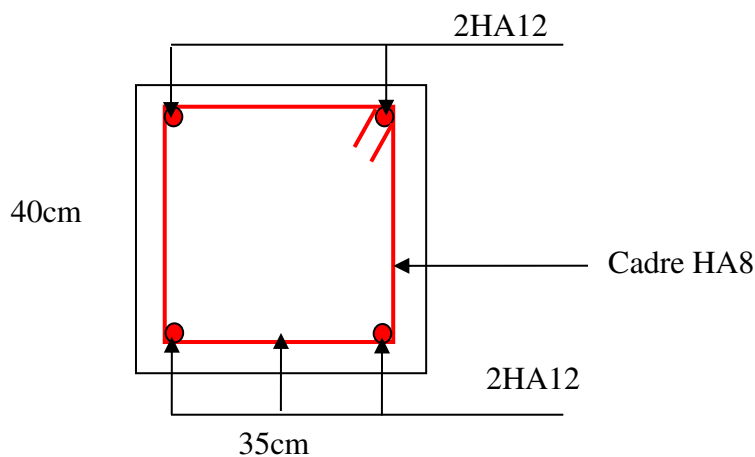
Schéma de ferrailage de la poutre de chaînage.
